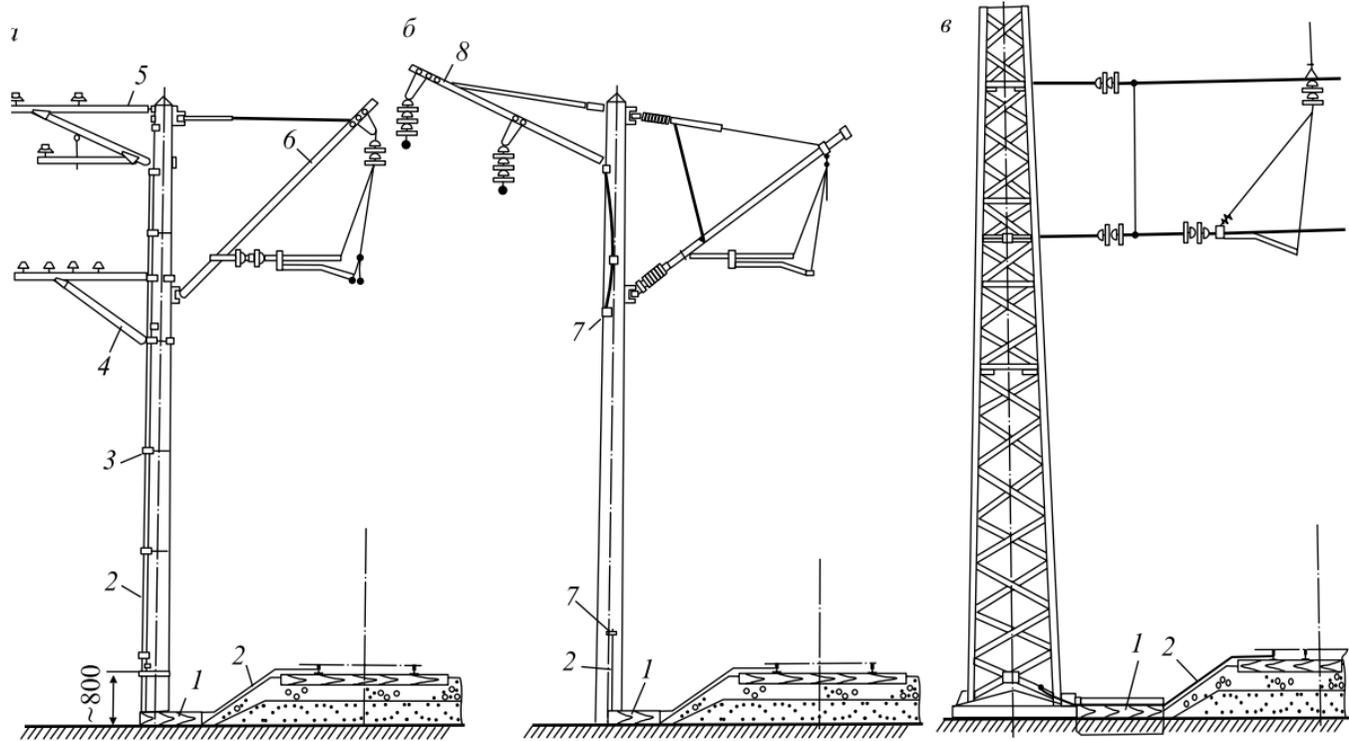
Схема заземлений на железобетонной и металлической опорах: *а* — железобетонная опора при постоянном и переменном токе; *б* — железобетонная опора при переменном токе (ранее применяемая схема); *в* — металлическая опора; 1 — полушпала; 2 — заземляющий проводник; 3 — деревянная или полимерная прокладка; 4 и 5 — кронштейн для проводов ВЛ 0,4 и ВЛ 6 (10) кВ; 6 — консоль; 7 — выходы заземляющего проводника; 8 — кронштейн провода ДПП
